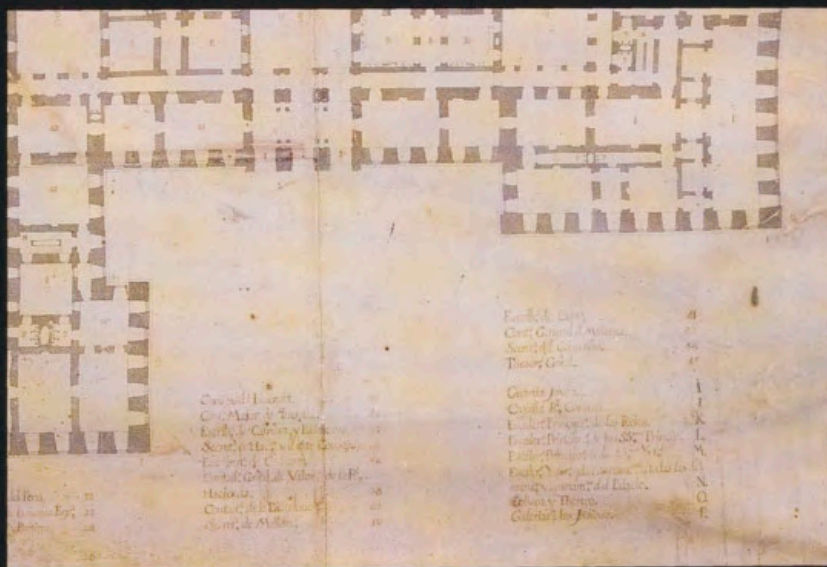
, Filippo Juvarra, Proyecto para el Palacio Real de Madrid, Detalle de la leyenda de la planta del piso bajo, AGP, Planos, 6.500, Madrid, Patrimonio Nacional.
